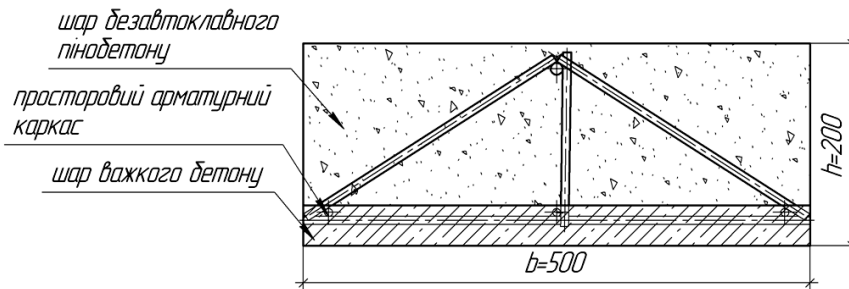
Поперечний переріз шарувато-залізобетонно-пінобетонної плити перекриття
